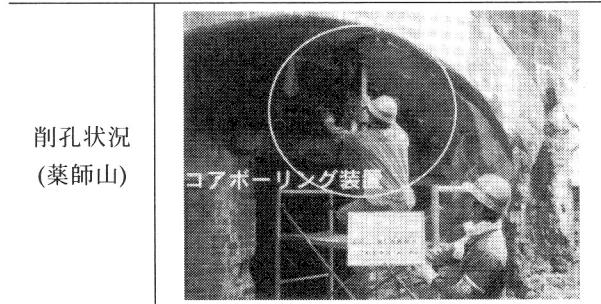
コンクリートの削孔状況 (撮影: 小林竜太)
